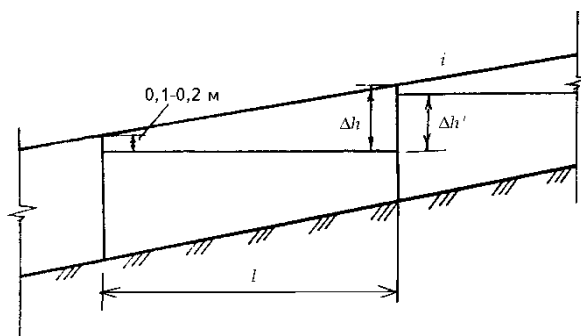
Схема к расчету расстояния между водоподпорными устройствами
